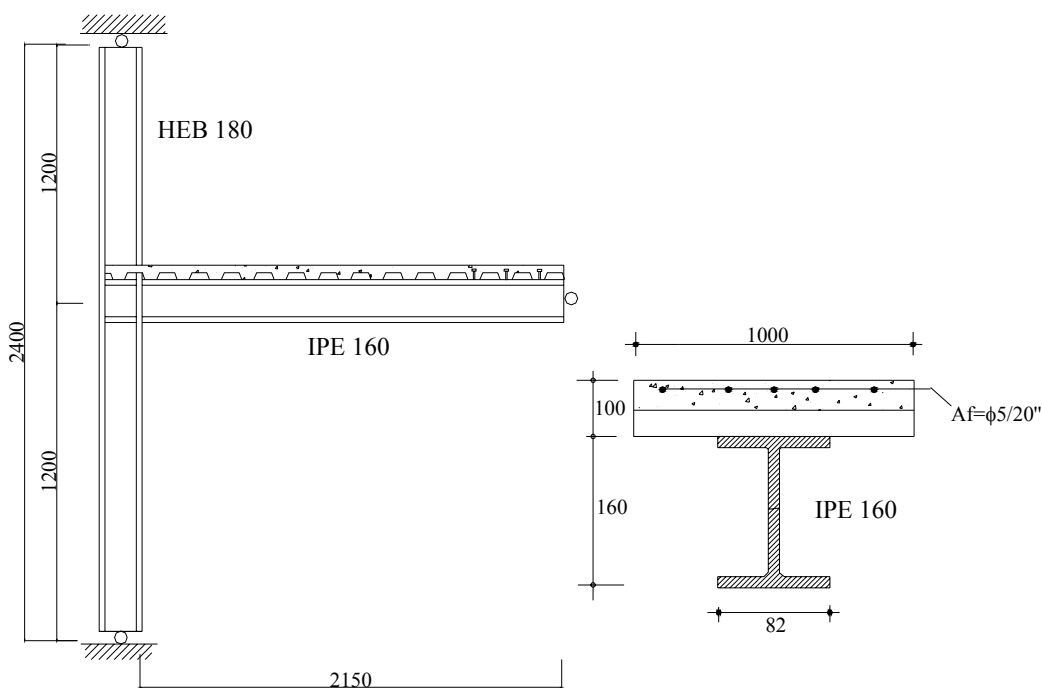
Geometria e dimensioni dello schema di prova del giunto con soletta in calcestruzzo armato su lamiera grecata.
